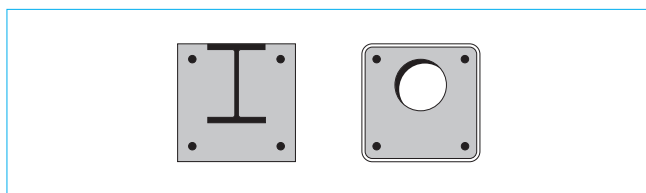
Exemples de sections monosymétriques de poteaux mixtes
